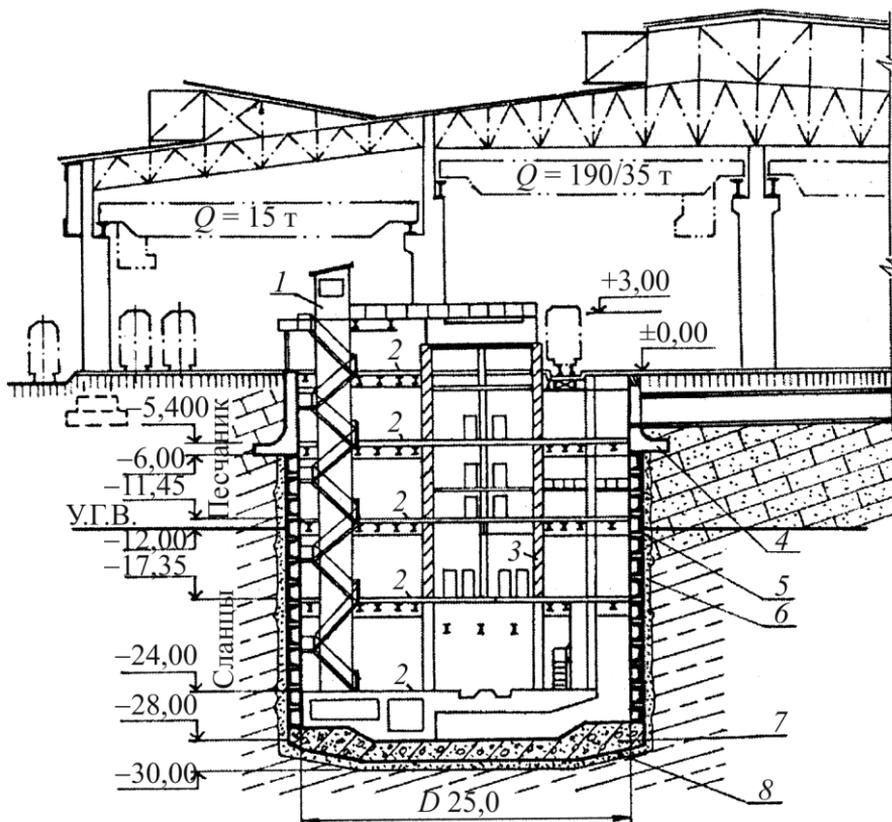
Возведение подземных сооружений подрачиванием: 1 – лифт; 2 – междуэтажные перекрытия; 3 – внутренняя камера; 4 – оголовок; 5 – тубинги; 6 – тампонажный слой; 7 – монолитное днище; 8 – гидроизоляция
